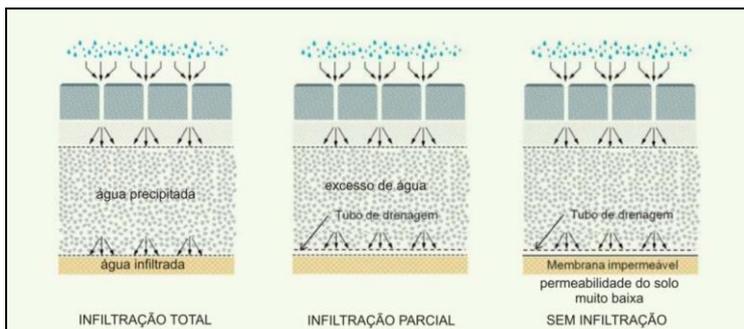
Tipos de infiltrações possíveis em pisos drenantes.
